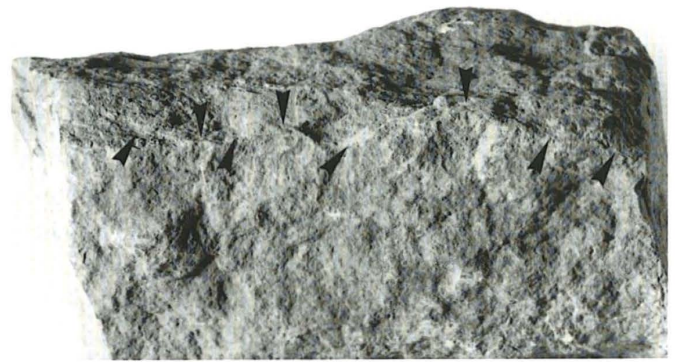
Frontstein (Nr. 21) mit Bearbeitungsspuren. Beispiel einer relativ sorgfältigen, wechselseitigen Kantenbearbeitung. Die Pfeile geben die Schlagrichtung an.
